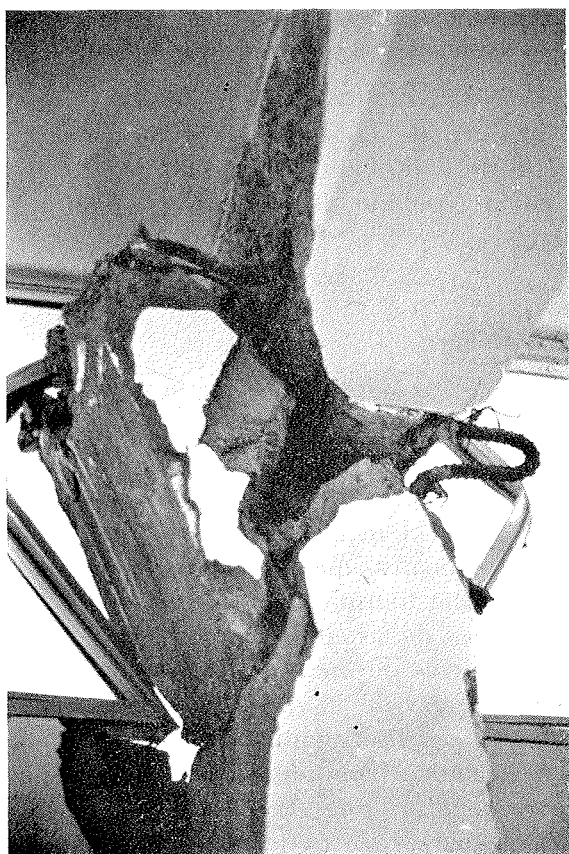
Unión viga-columna, destruida por falta de refuerzo transversal (estribos). Debe evitarse este tipo de columna "corta" creada por la colocación de tabiques con ventana alta, a los lados de la columna. Su enorme rigidez atrae sobre sí grandes fuerzas de corte.
